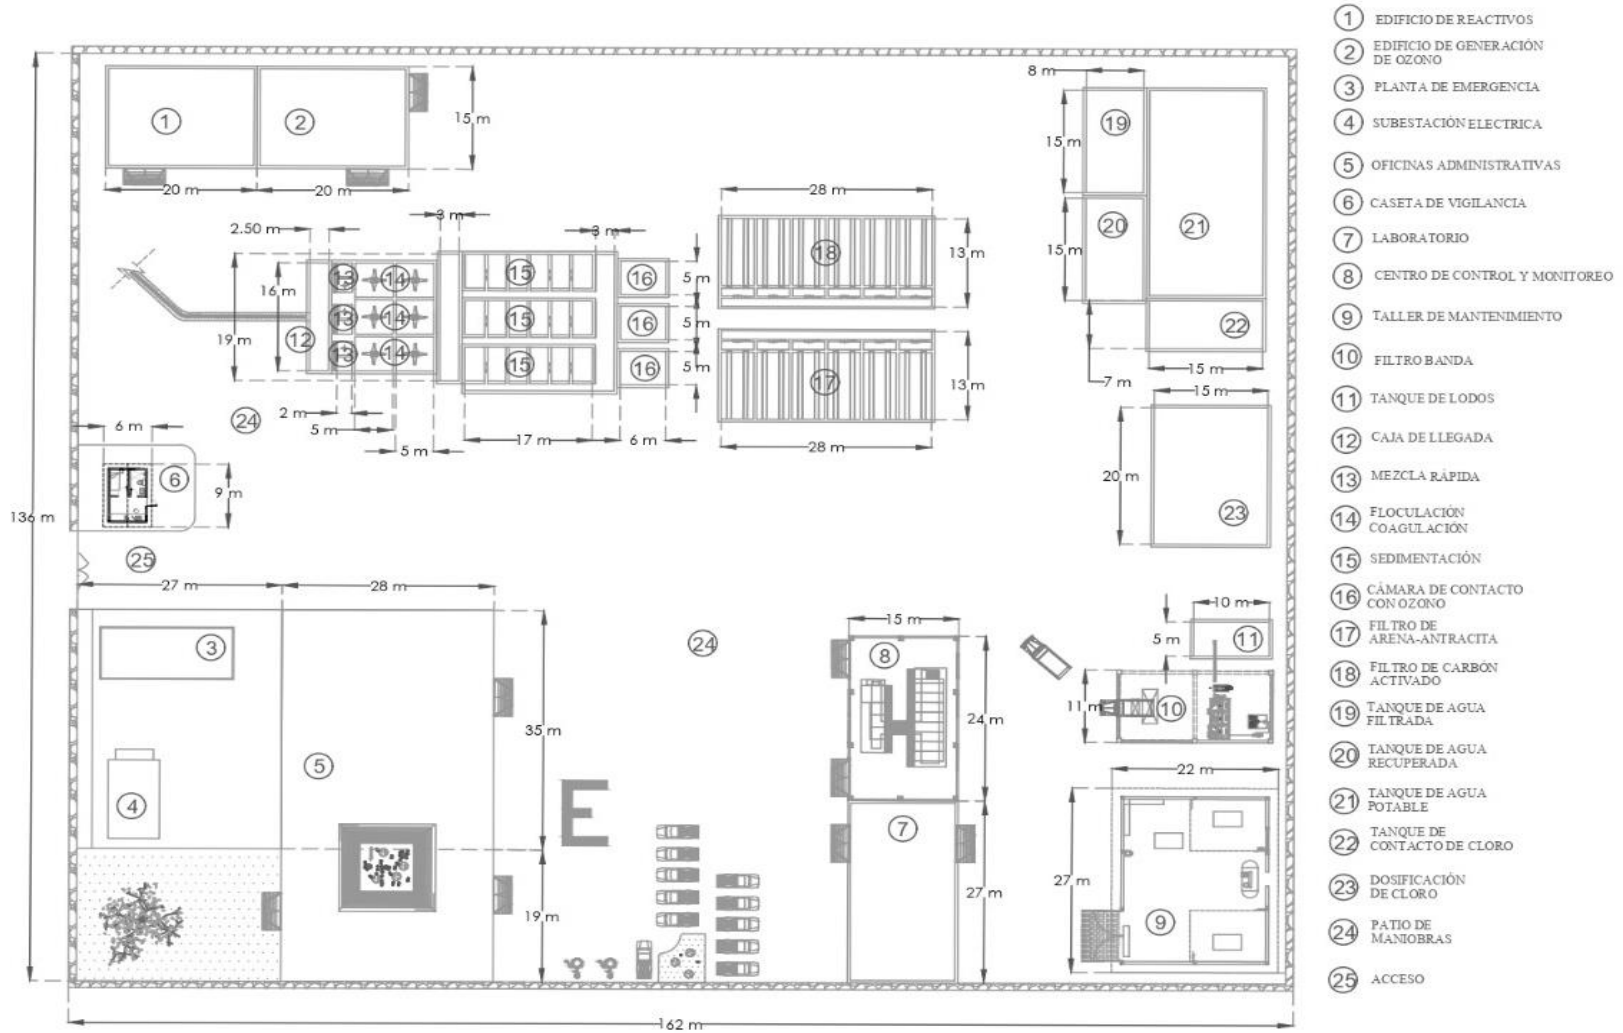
Dimensionamiento de la Planta Potabilizadora.
